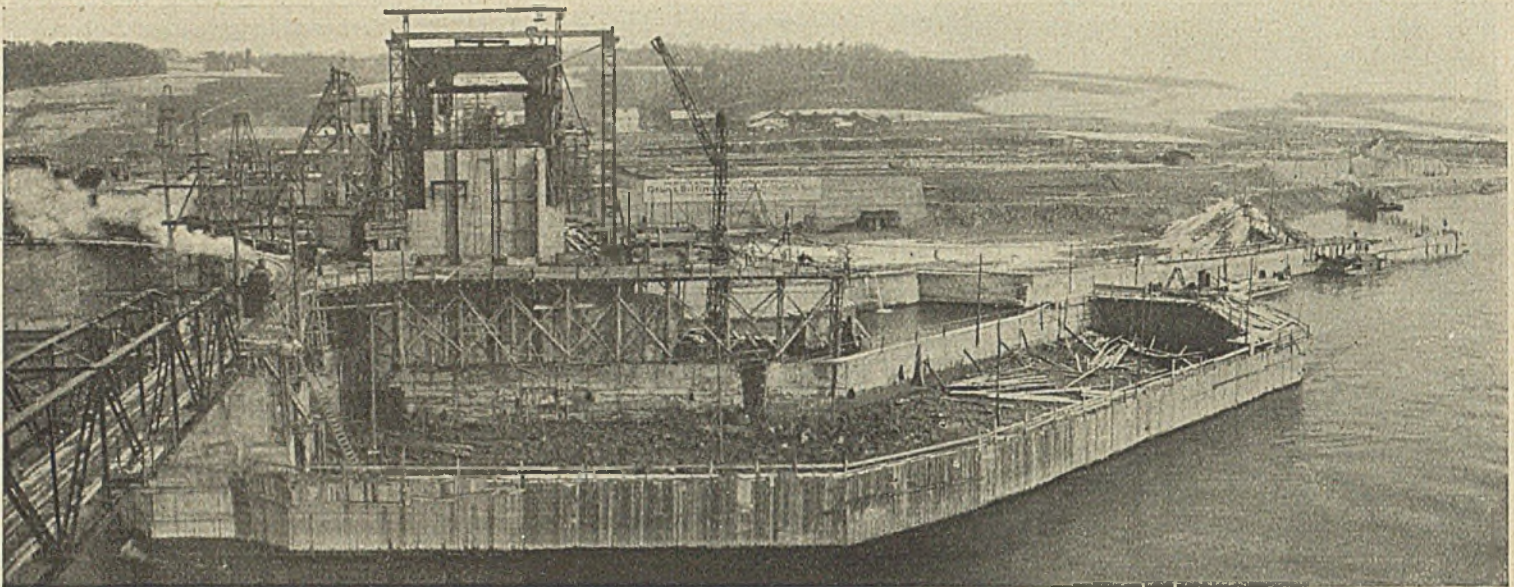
Umschließung einer Wehrbaugrube mit Betonfangdämmen.
